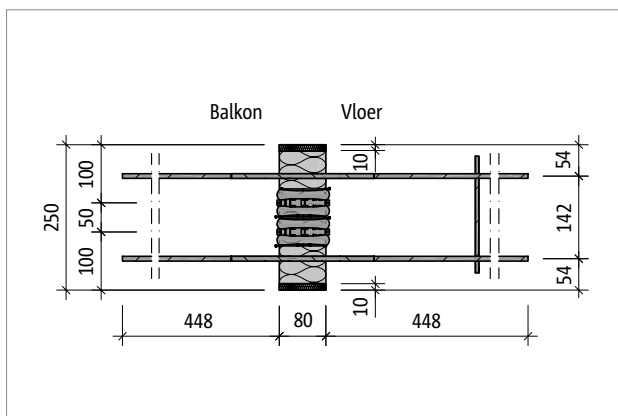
Schöck Isokorf® T type Q-E-V5: Bovenaanzicht
